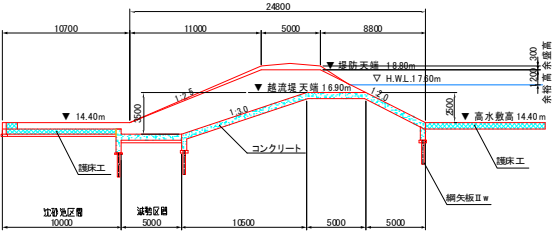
遊水地（5.6k 左岸）越流堤横断面図
